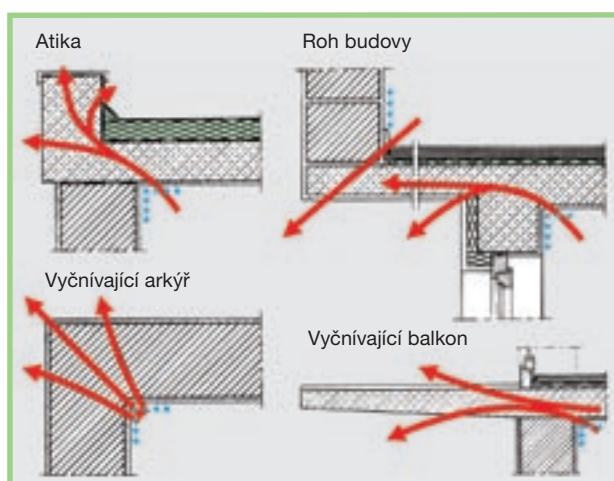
Izolace tepelných mostů na betonových stavebních prvcích:
